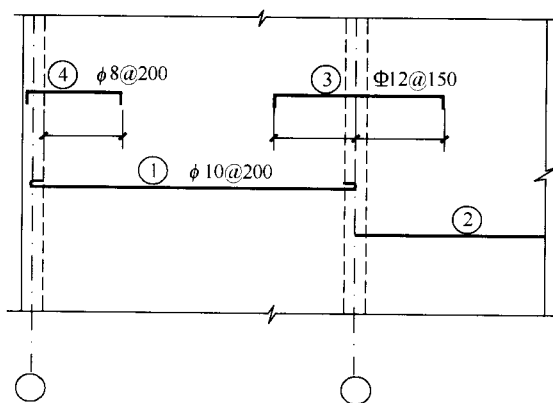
钢筋在楼板配筋图中的表示方法
